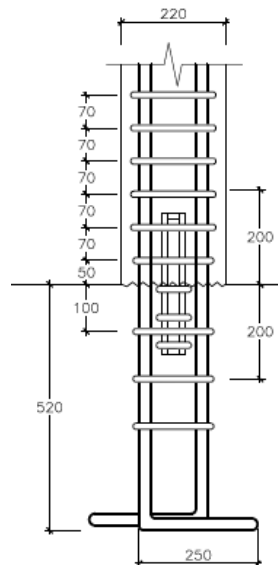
Detalle de armadura de refuerzo de columnas en su base para unión con zapatas
